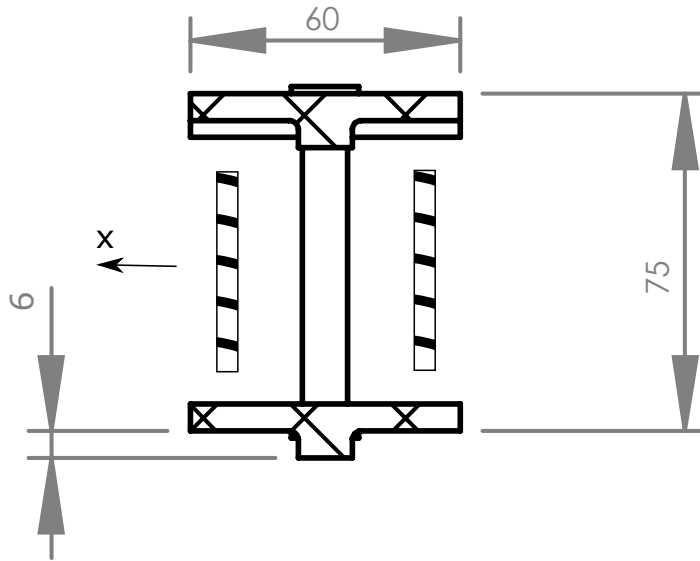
Coupe de la section d’une membrure (dimensions en mm) et section de la courroies hachurées.
